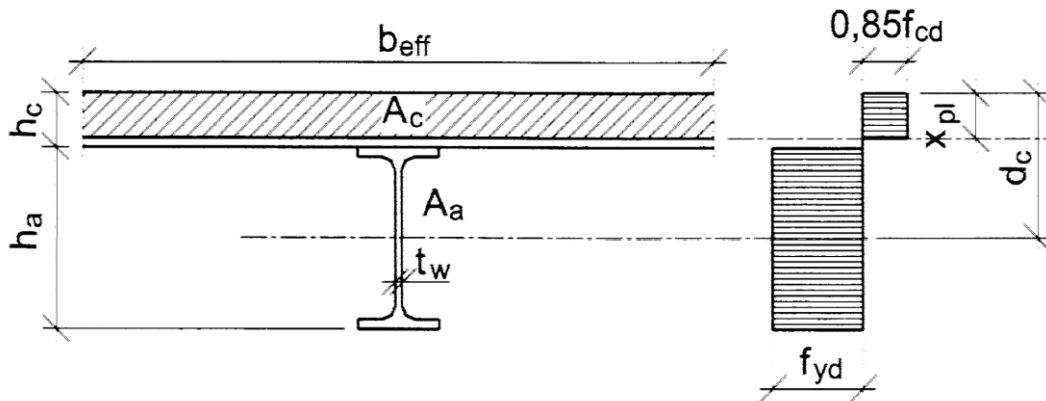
Эпюра напряжений в сталежелезобетонном сечении при расположении нейтральной оси в бетонной плите пластической стадии работы
